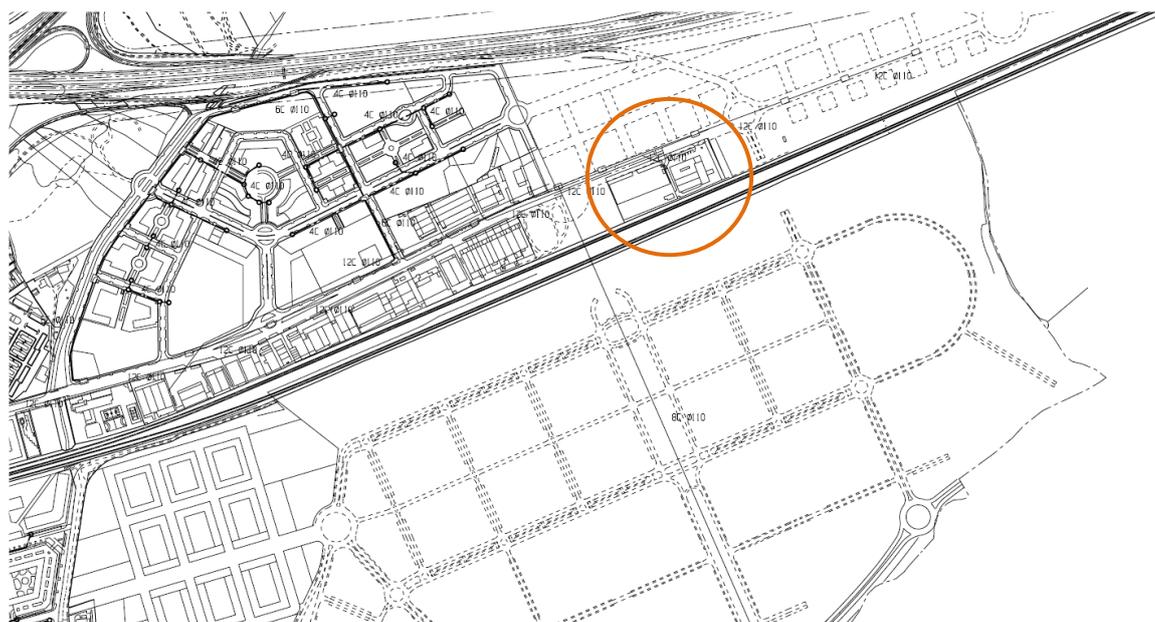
Plano de distribución de telefonía de la RPGOU 01
